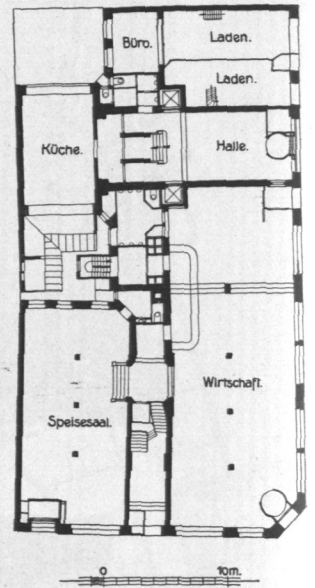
Hotel Berliner Hof, Erdgeschoß, Grundriß.
